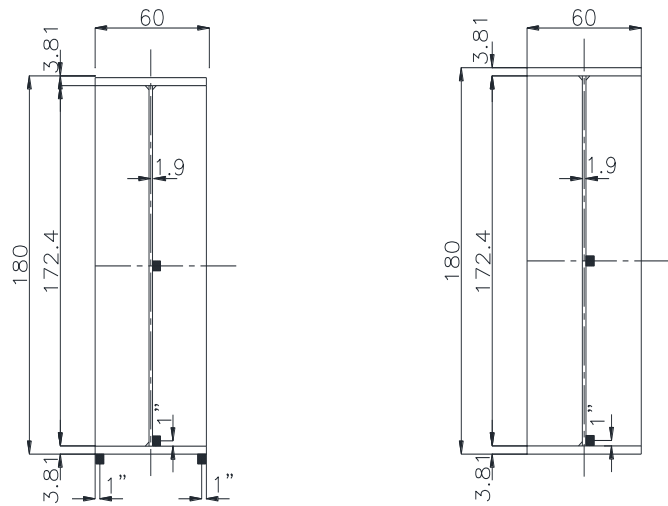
Ubicación de strain gage en la sección transversal de viga V-20.
